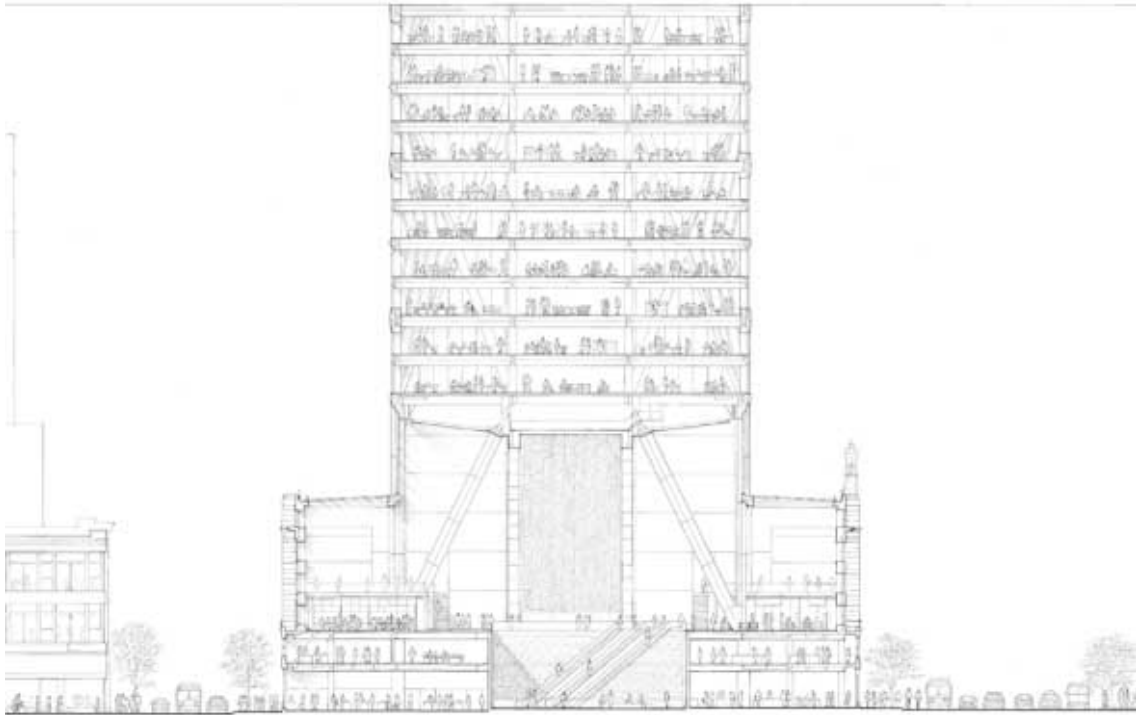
Alzado este. Fuente: Foster+Partners. (2010). *Hearst Tower
